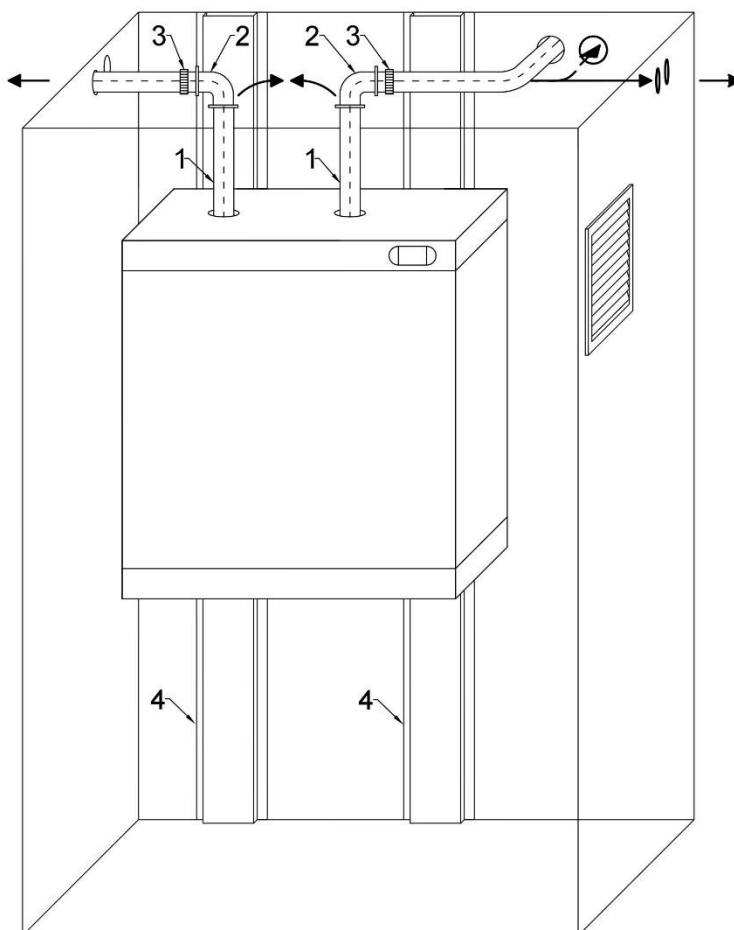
Konstrukcja wsporcza podstawy obudowy
